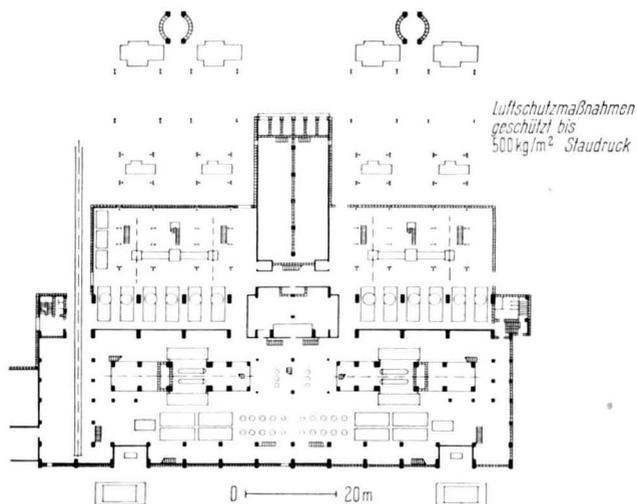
Kraftwerk, Block II und III. - Grundriß ± 0,00.
